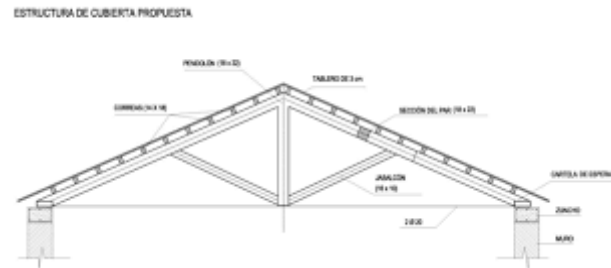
estructura de techo. Fuente: manual de la construcción de viviendas de madera (Chile)
